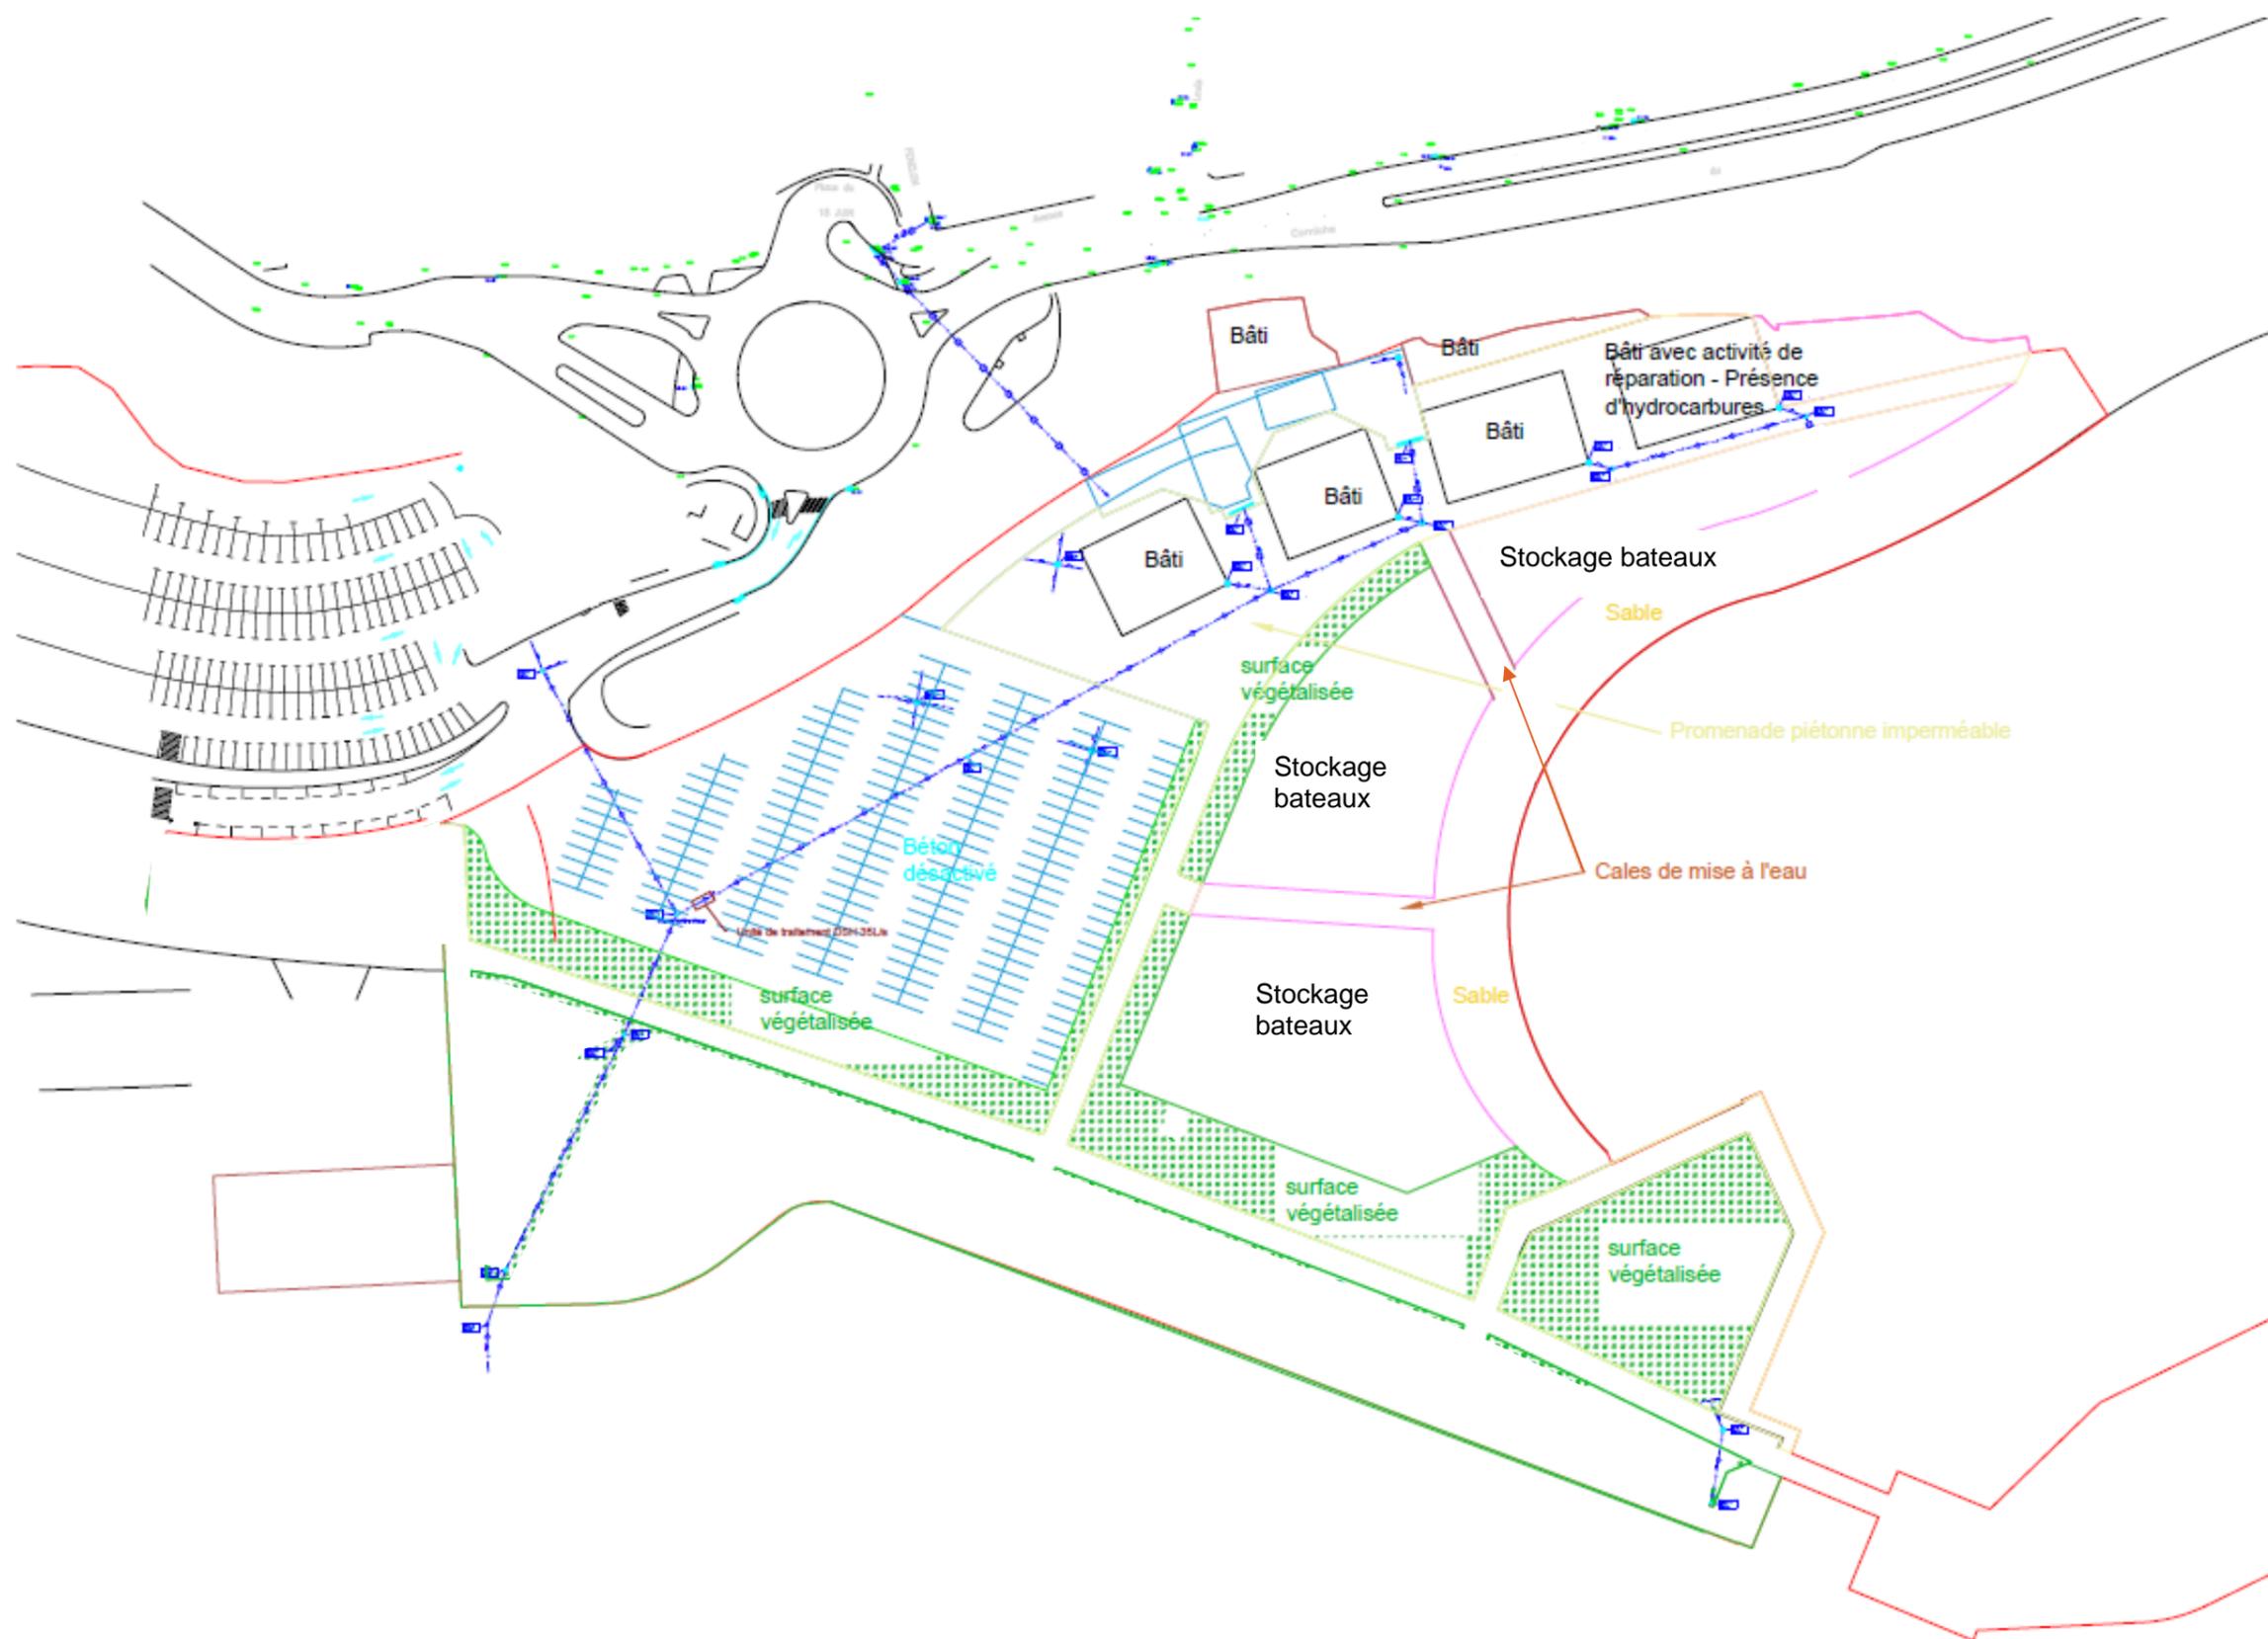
Extrait du plan de principe du projet de reconstruction de la base de Tabarly
